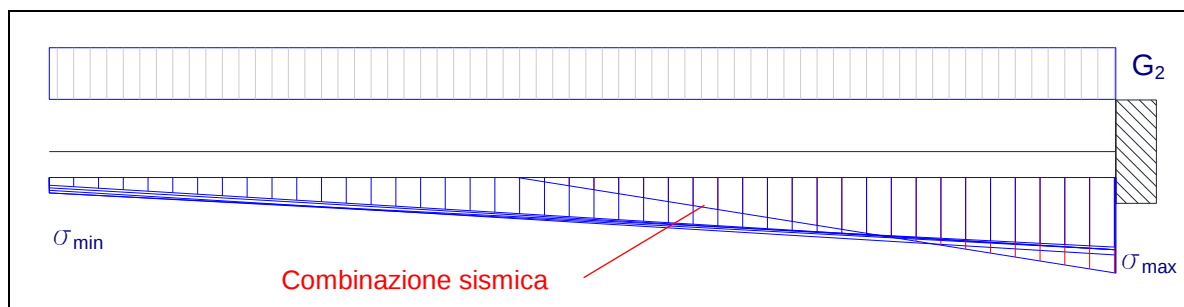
Spalla A – Schema statico di carico assunto (si evidenzia che la combinazione sismica induce una risposta del terreno parzializzata)
